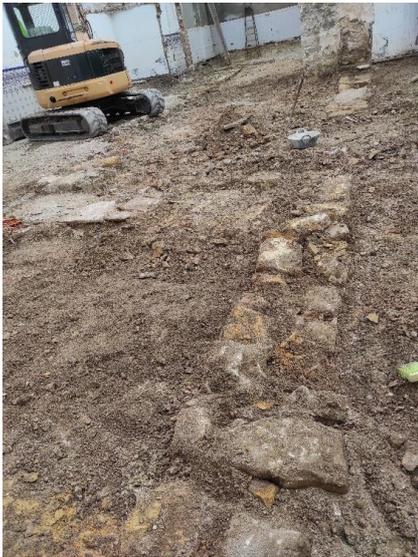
Detalle aparición de muro UE 6, bajo US 3
